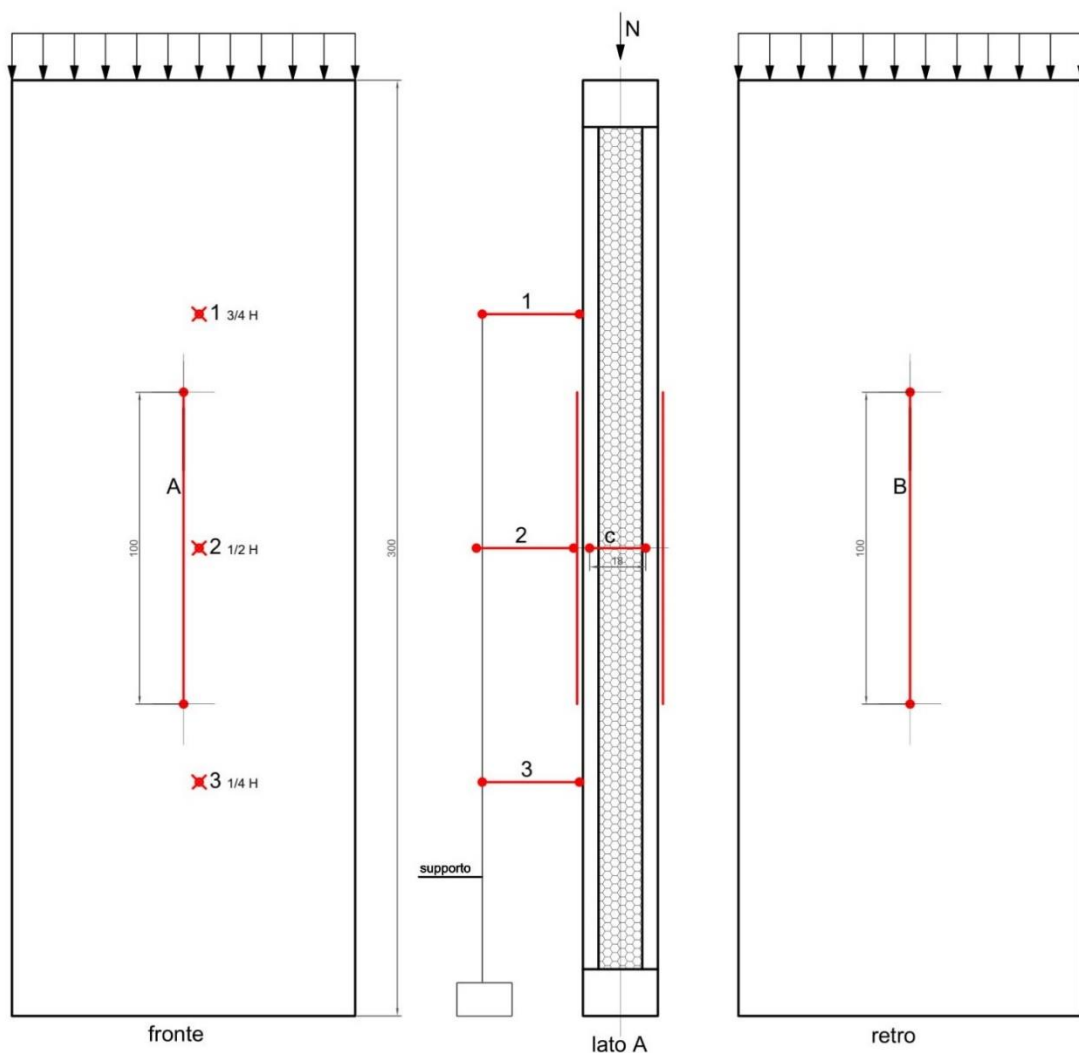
Disposizione dei trasduttori sulle facce e retro, lato A del provino
